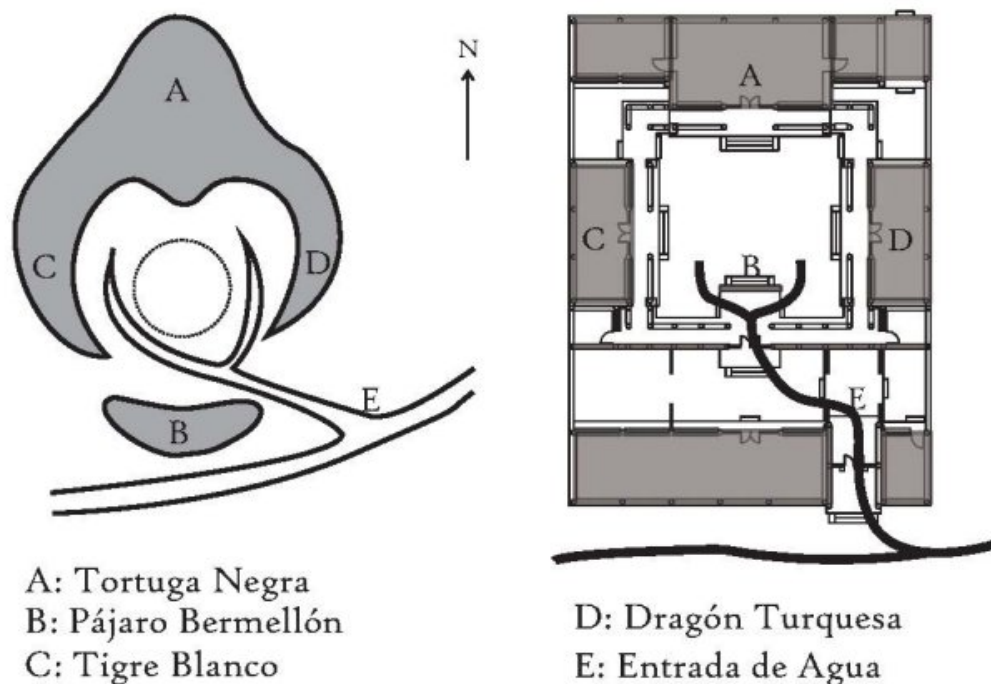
Modelo del *fēngshuǐ* ideal aplicado a interiores de edificios, en concreto a una casa patio.
